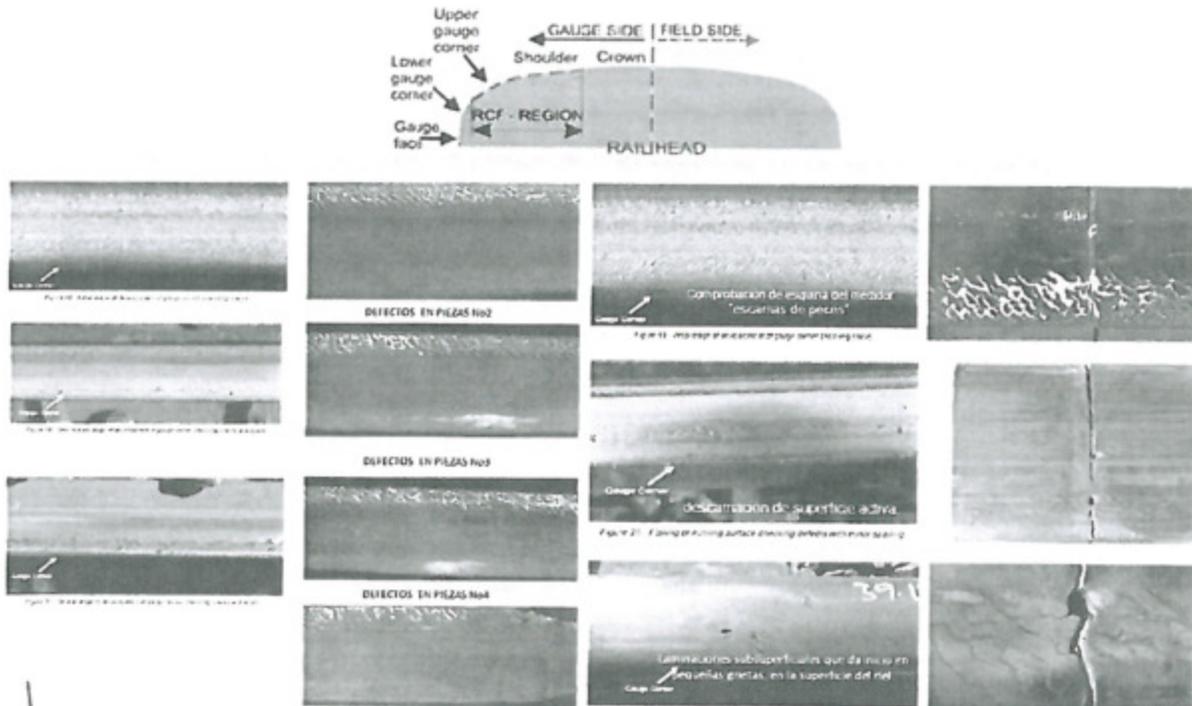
Defectos por fatiga por contacto rodante del riel involucrado en el Siniestro
